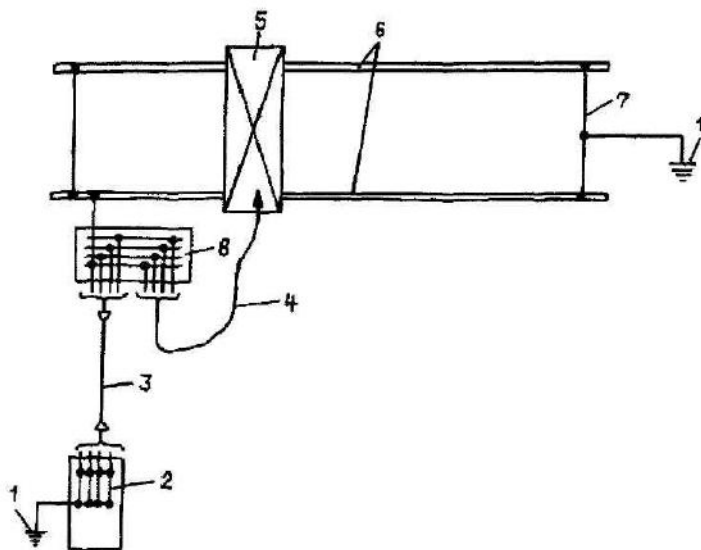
Схема заземления (зануления) крана, установленного на открытом воздухе и питающегося по гибкому кабелю 1 — заземлитель; 2—вторичная обмотка питающего трансформатора; 3 — неподвижный четырехжильный питающий кабель; 4 — гибкий переносной питающий кабель; 5 — кран; 6 — рельсовые пути крана; 7—перемычка; 8—вводно-распределительное устройство
